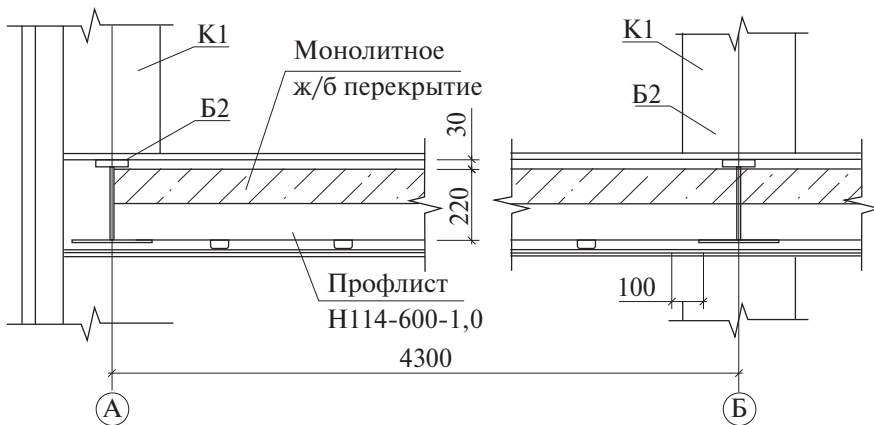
Разрез по плите перекрытия (см. раздел «Формирование конечно-элементной модели несущей системы здания»)
